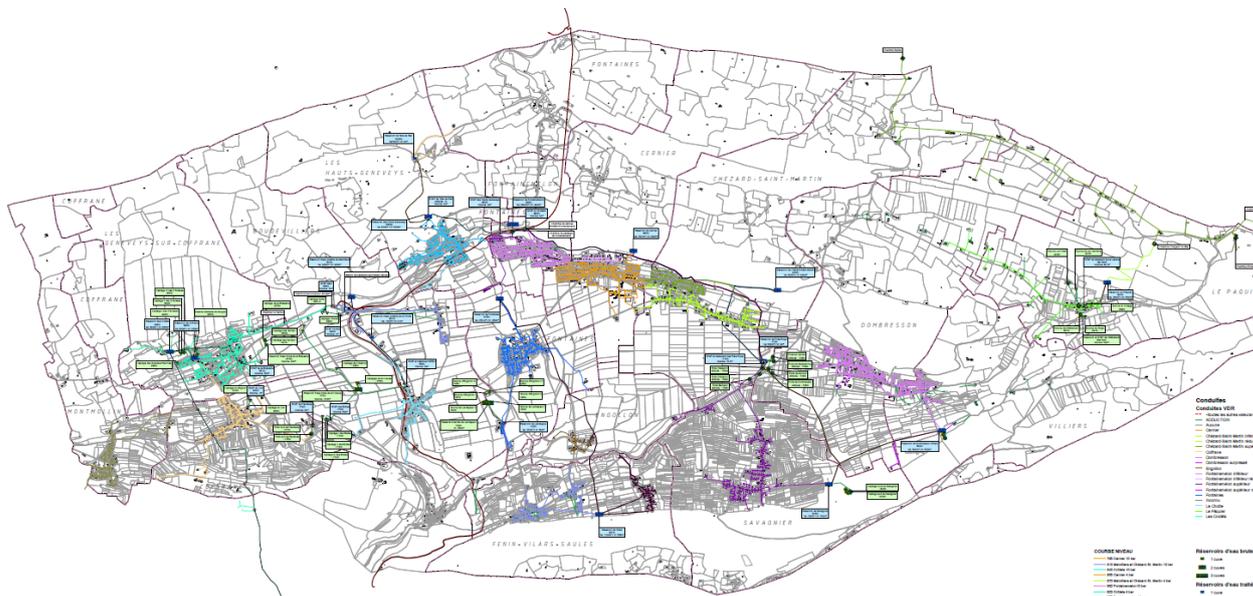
Plan de situation – État actuel (cf Plan 1)
